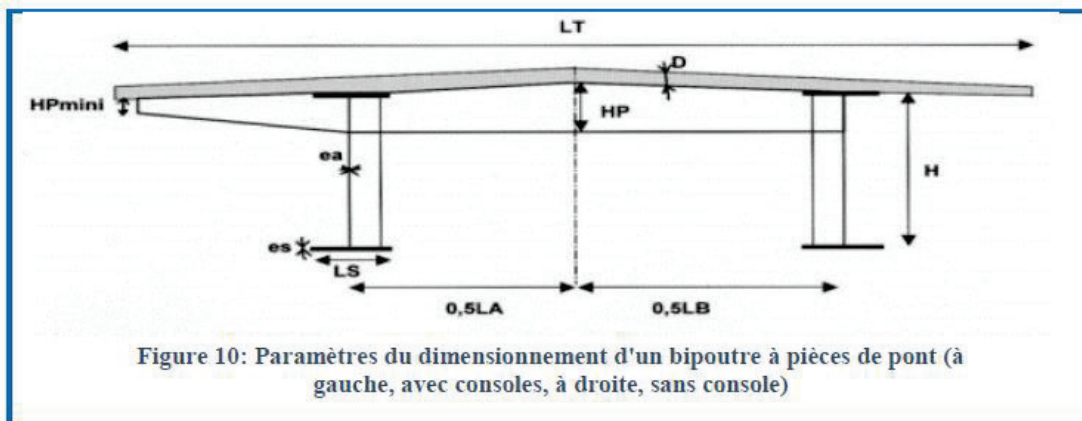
Paramètres du dimensionnement d'un bipoutre à pièces de pont (à gauche, avec consoles, à droite, sans console)
